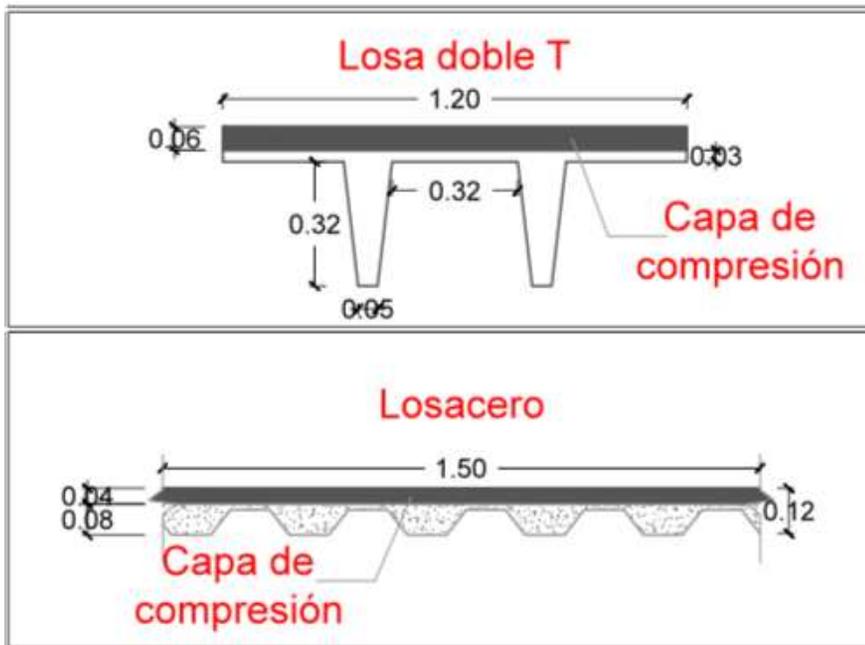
Losa doble T y Losacero, desarrollo de anteproyecto
